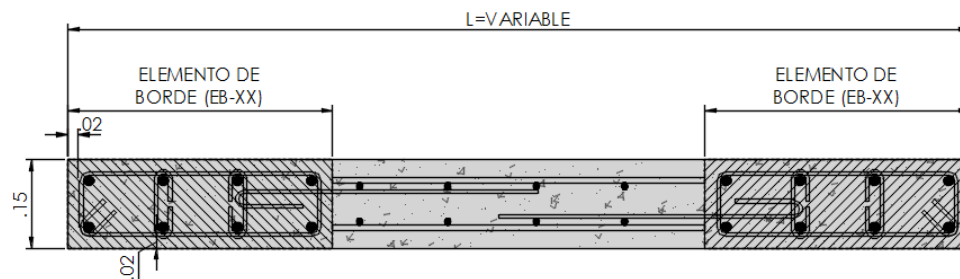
Detalle típico de muro con confinamiento en sus extremos. Fuente: Imágenes de planos DUAL INGENIERÍA ESTRUCTURAL SAS. Archivo personal, recuperado en el 2017.
